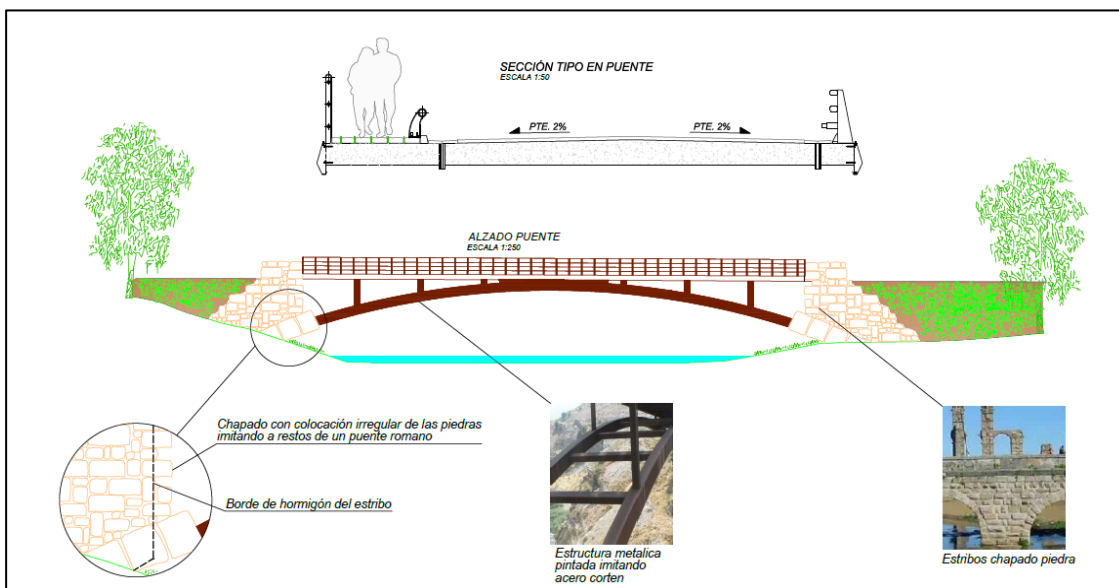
plano en alzada del viaducto proyectado para la Loma de Mari-Ángela
